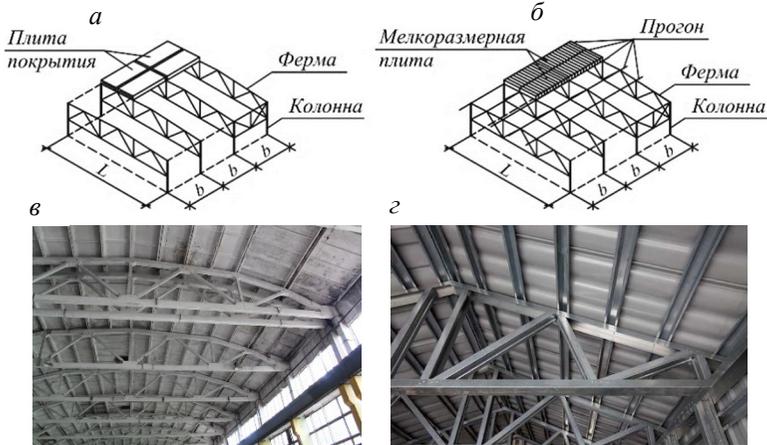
Конструктивные схемы ограждающей части покрытия: *a* — беспрогонная; *б* — по прогонам; *в* — беспрогонное покрытие по железобетонным фермам; *г* — прогонное покрытие по металлическим фермам
